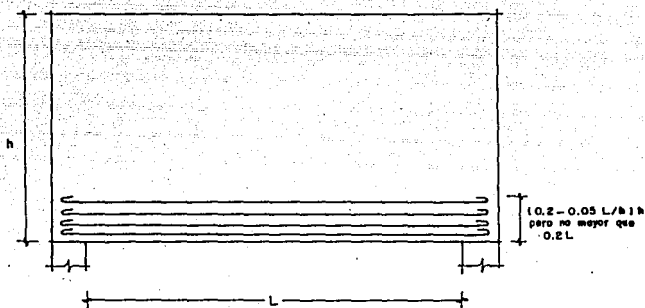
Disposicion del refuerzo de flexion en viga diafragma de un claro (Ref.17)
